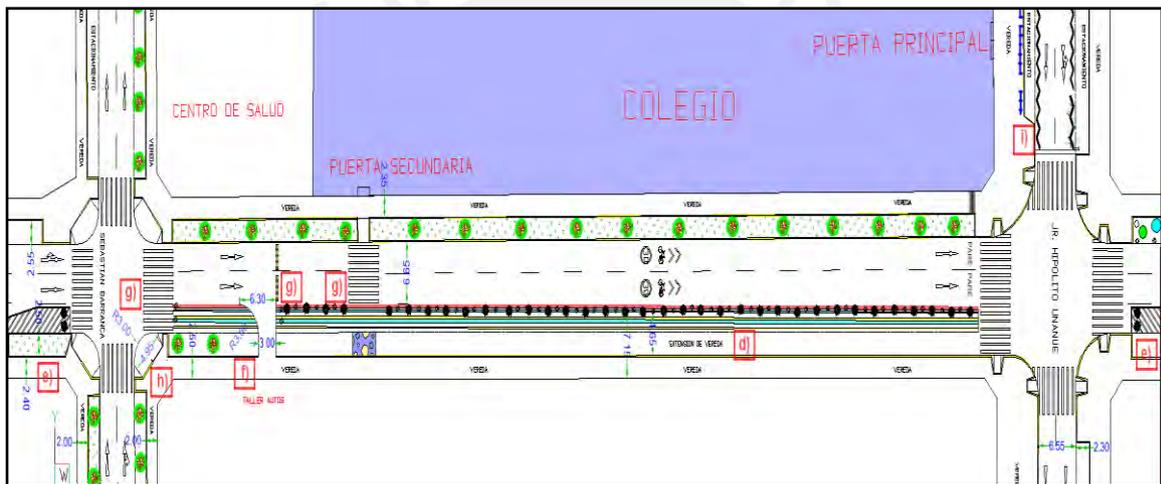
Vista en planta de situación propia en la Av. Cangallo frente al colegio.
